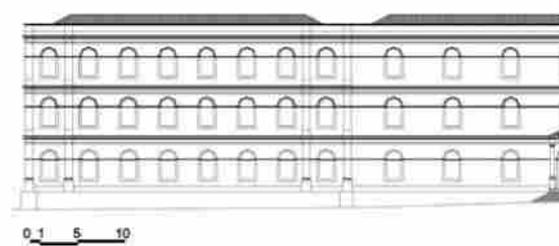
Trecho do Levantamento Arquitetônico da Fachada do Hospital Pedro II. Fonte: da Autora.
